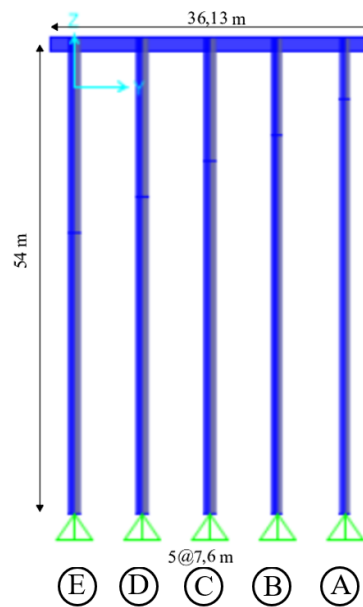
Vista elevación plano Y-Z muelle transparente
